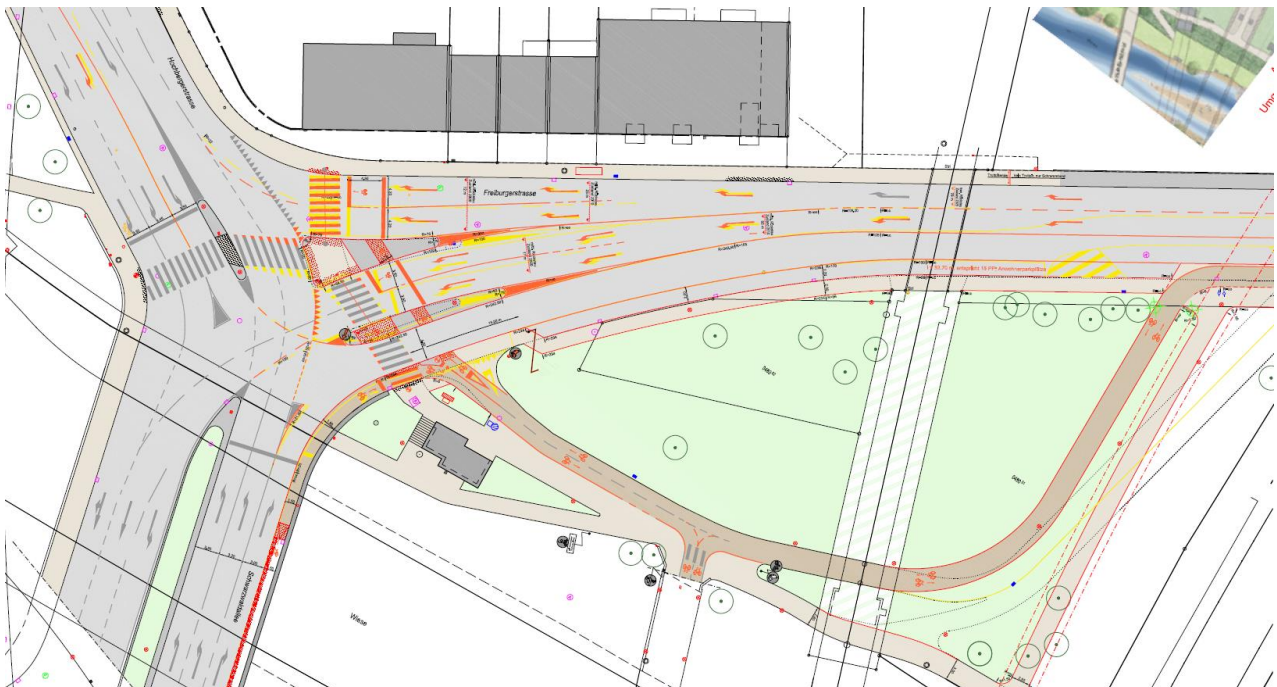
; Projekt – Planausschnitt, Abschnitt A
